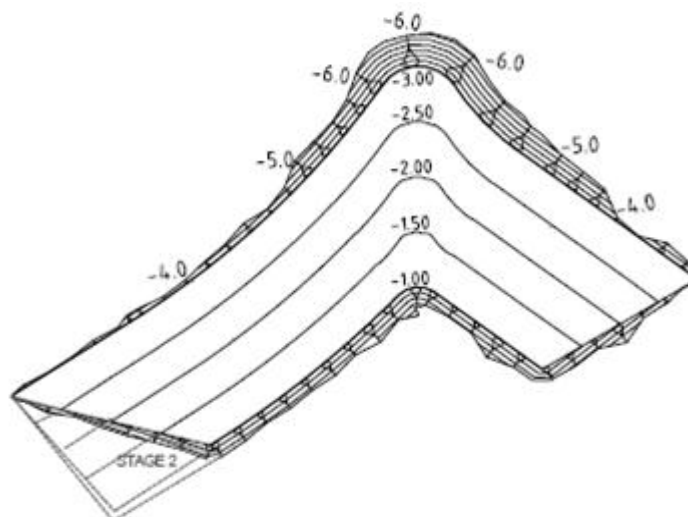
Planta inicial do recife de Cables (adaptado de Jackson e Corbett, 2007)
